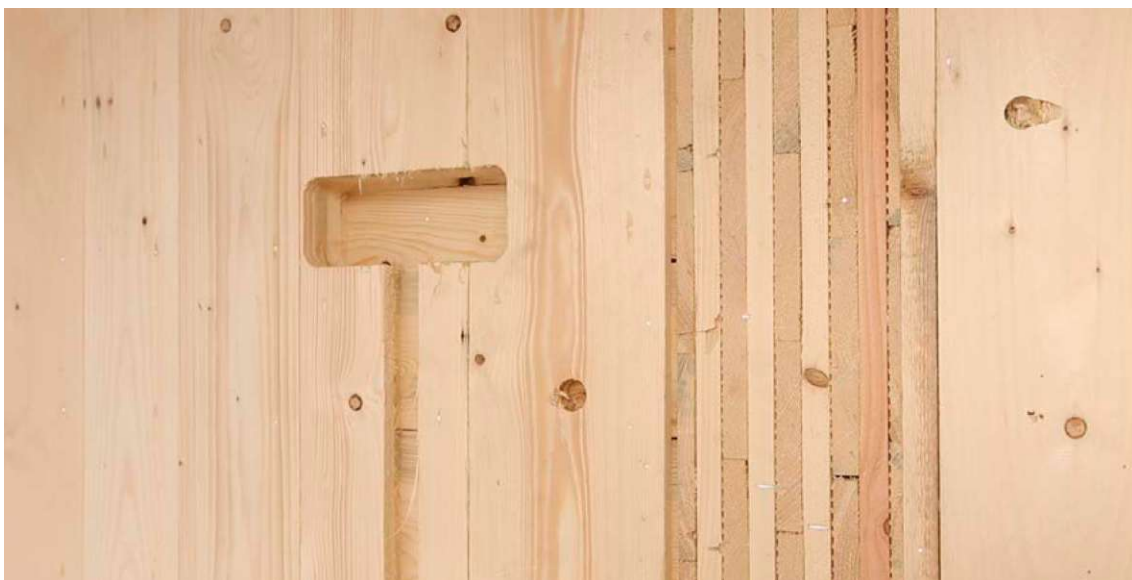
Im Vordergrund Schichtaufbau Wandelement; im Hintergrund im Werk vorbereitete Aussparung für Gebäudetechnik
